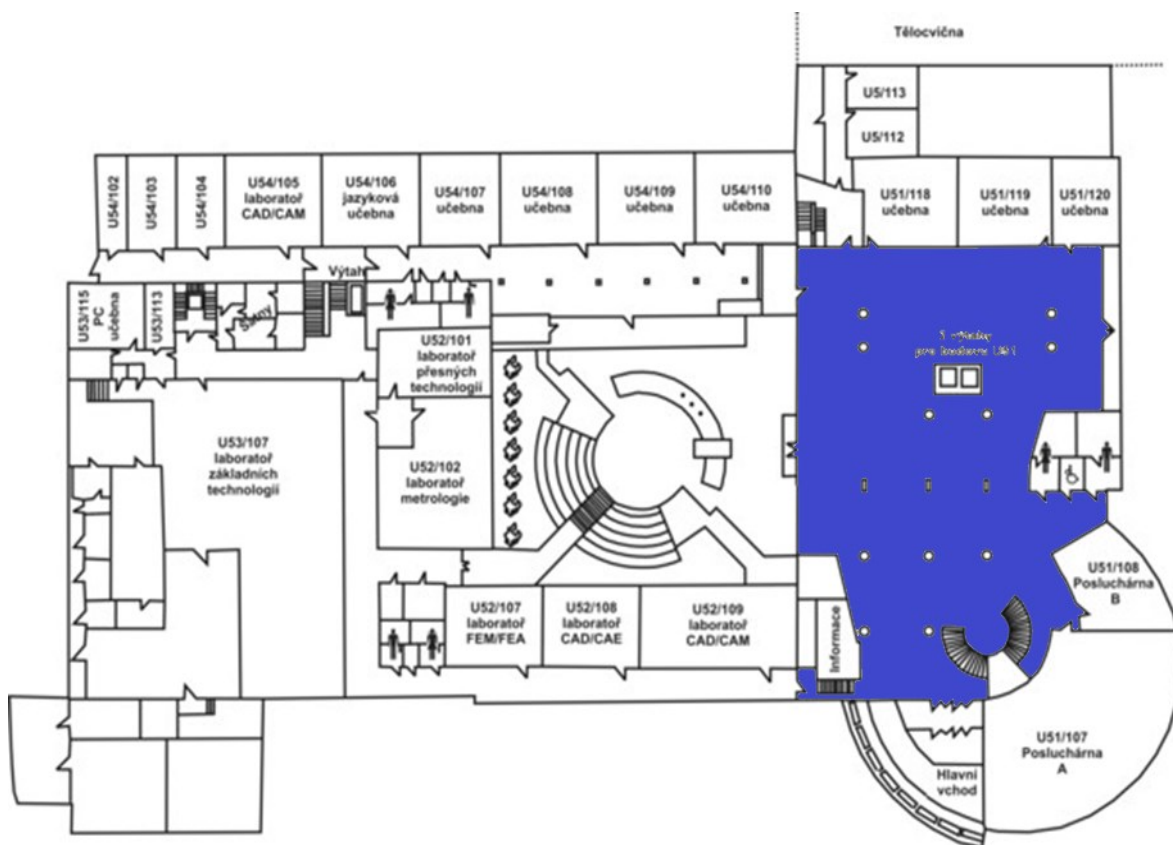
Půdorys 2. nadzemního podlaží FAI [zdroj vlastní]
